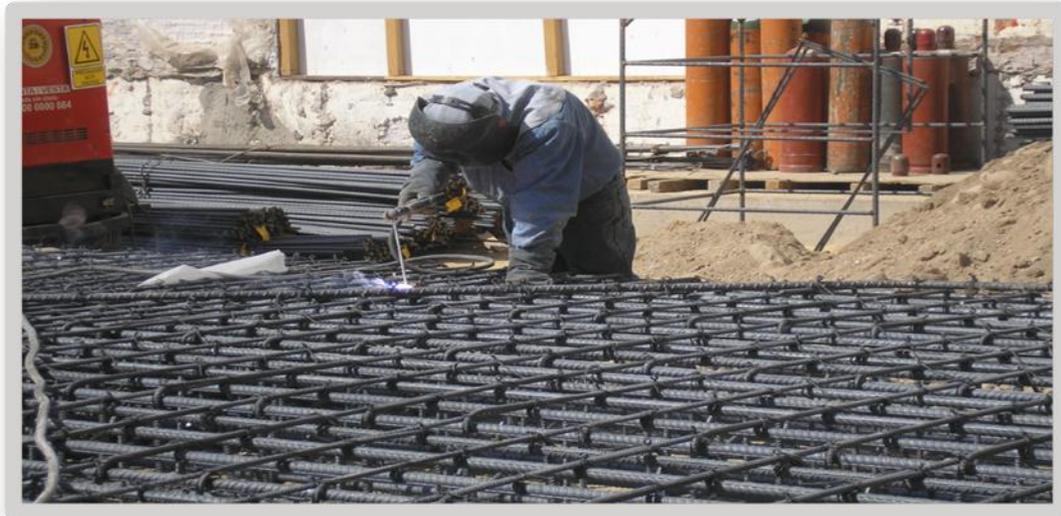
Trabajos de soldadura en el armado
